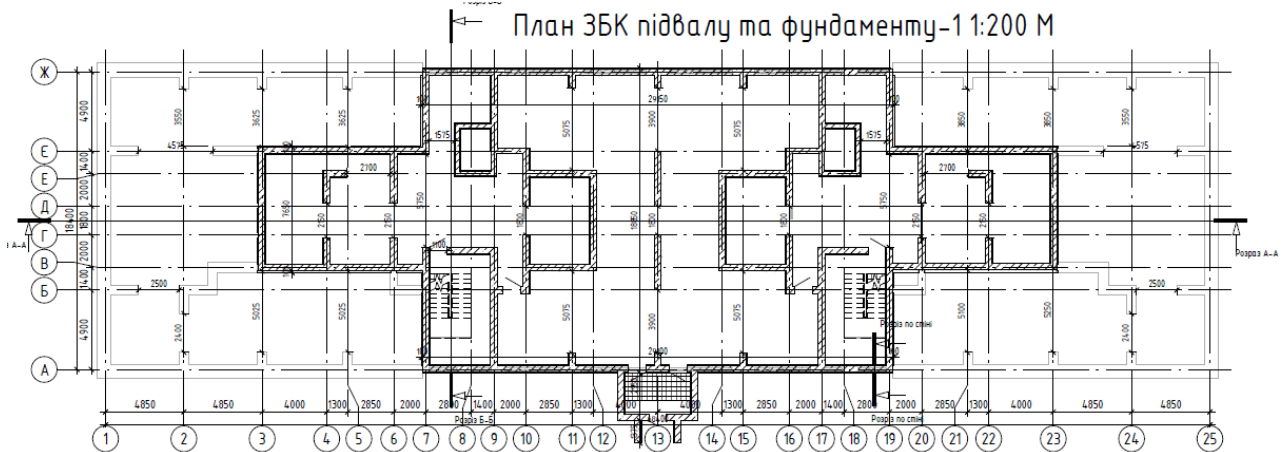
План фундаменту у будинку тип Б-1.
